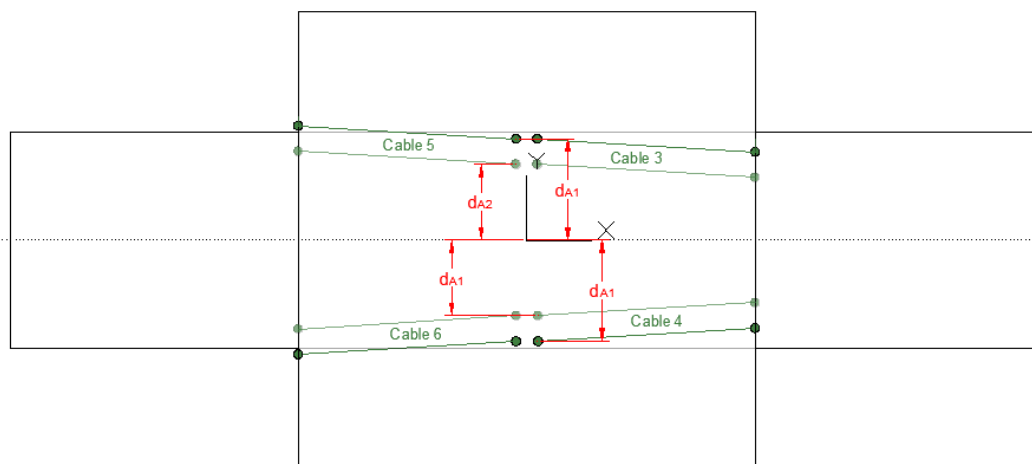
Vista en planta del sistema para aclaración del parámetro d_A
